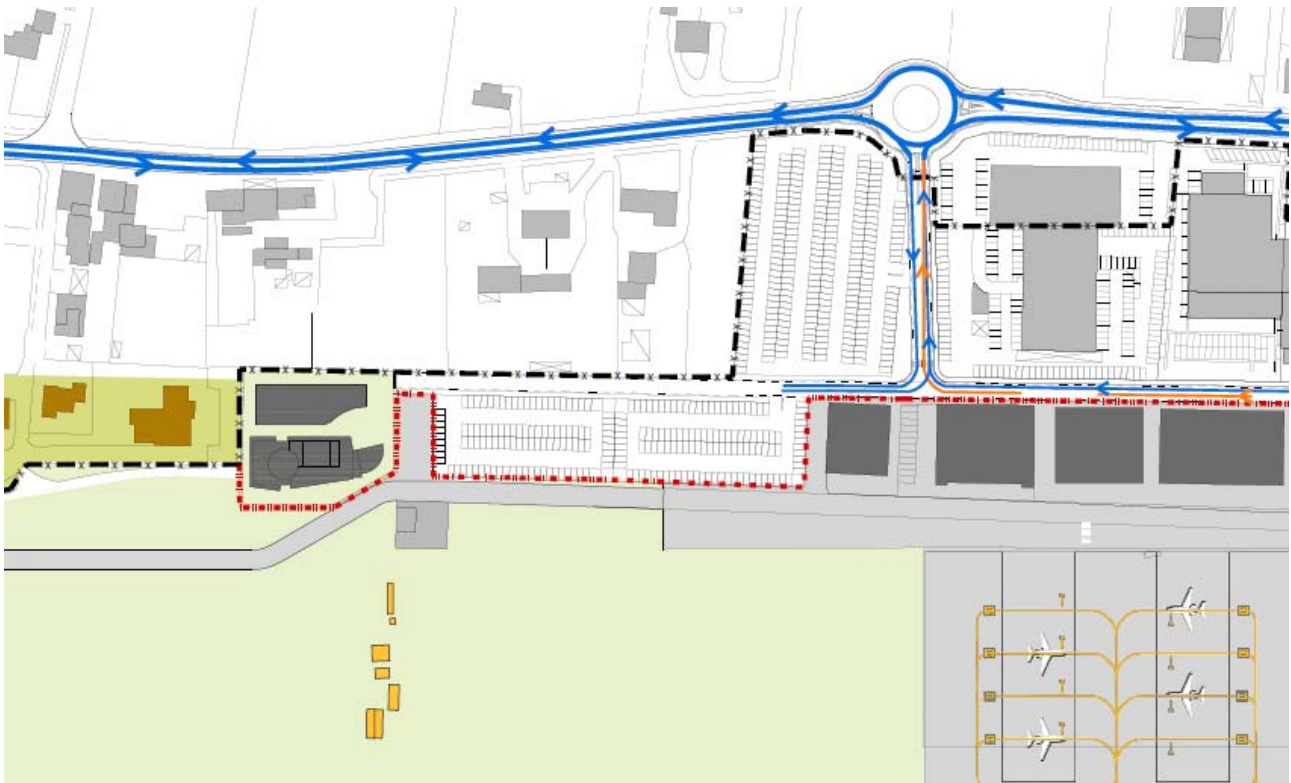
Nuova torre di controllo, schema di accessibilità e schema planimetrico. In blu i flussi veicolari, in tratteggio rosso il limite doganale. Elaborazione One Works.
